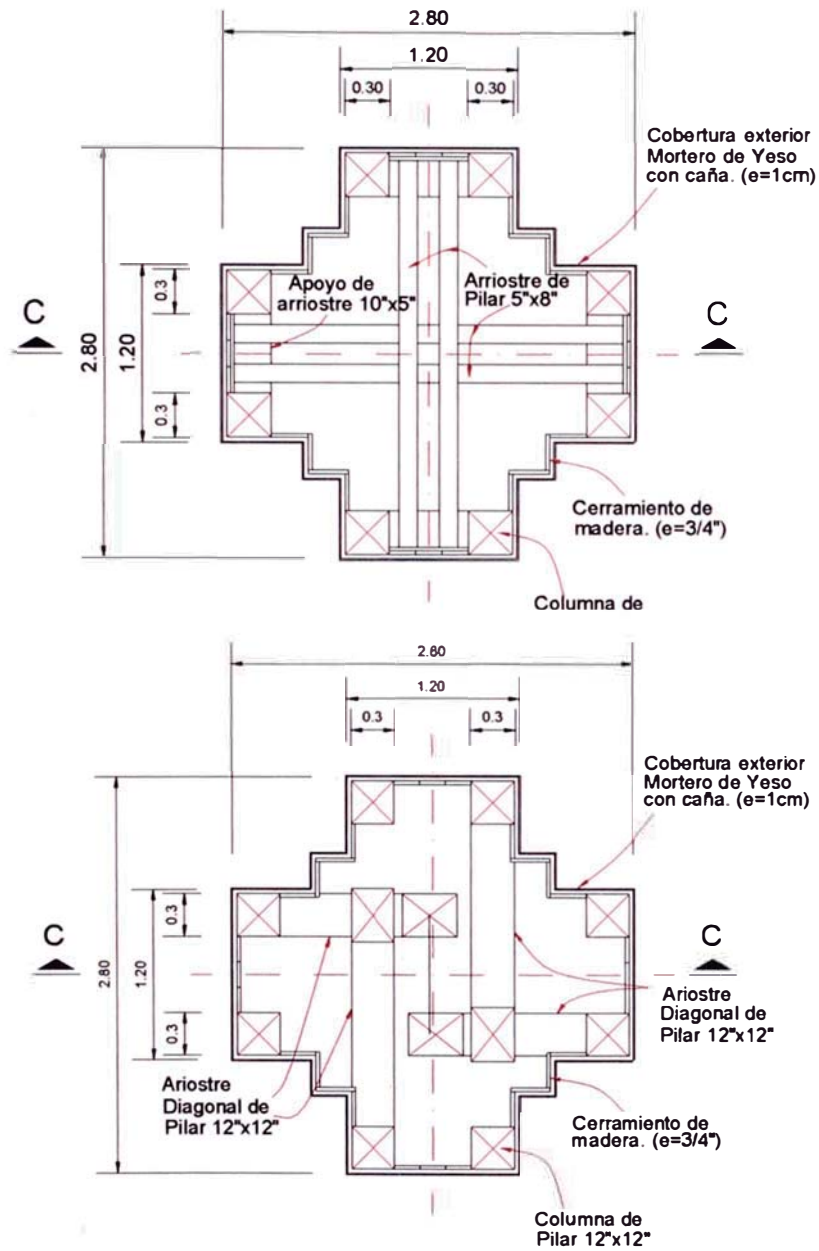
Cortes A-A y B-B de la sección del pilar. (ver Fig. 4.5)
